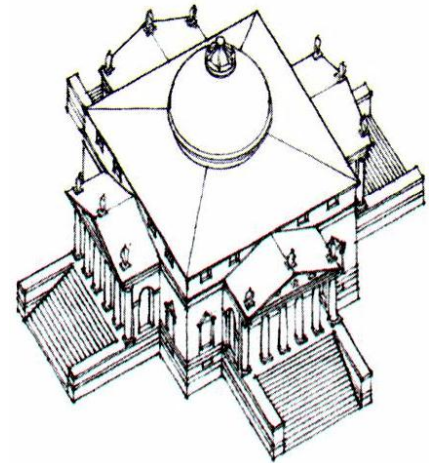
Planta Villa Capra (Rotunda), Vicenza, 1552-1567, Andréa Palladio
